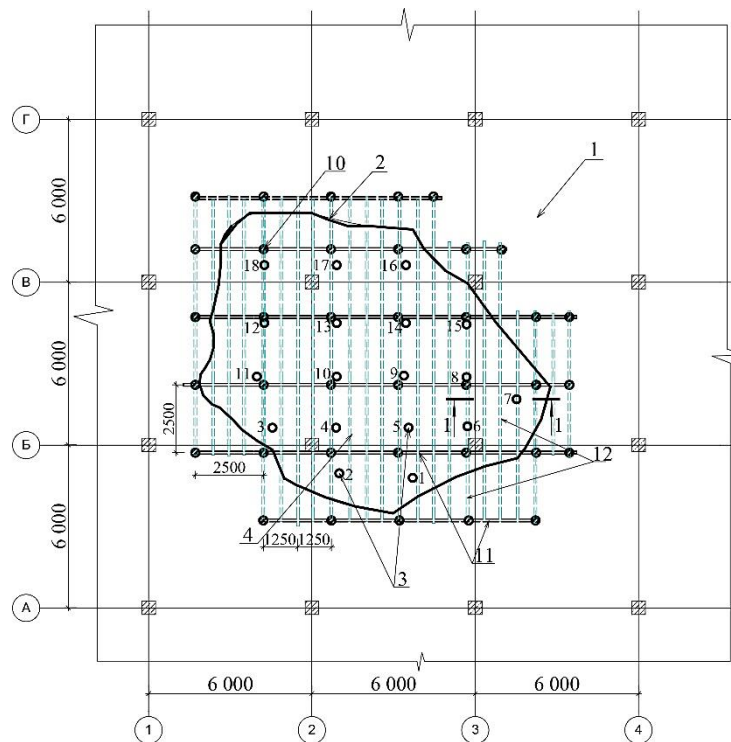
Схема розміщення анкерних кріплень для опалубного щита.
